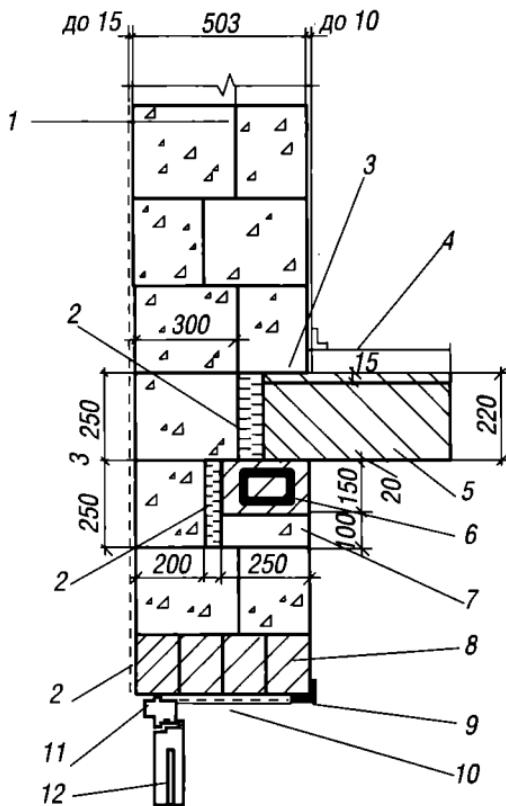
Узел опирания плиты перекрытия на стену из ячеистобетонных блоков:
